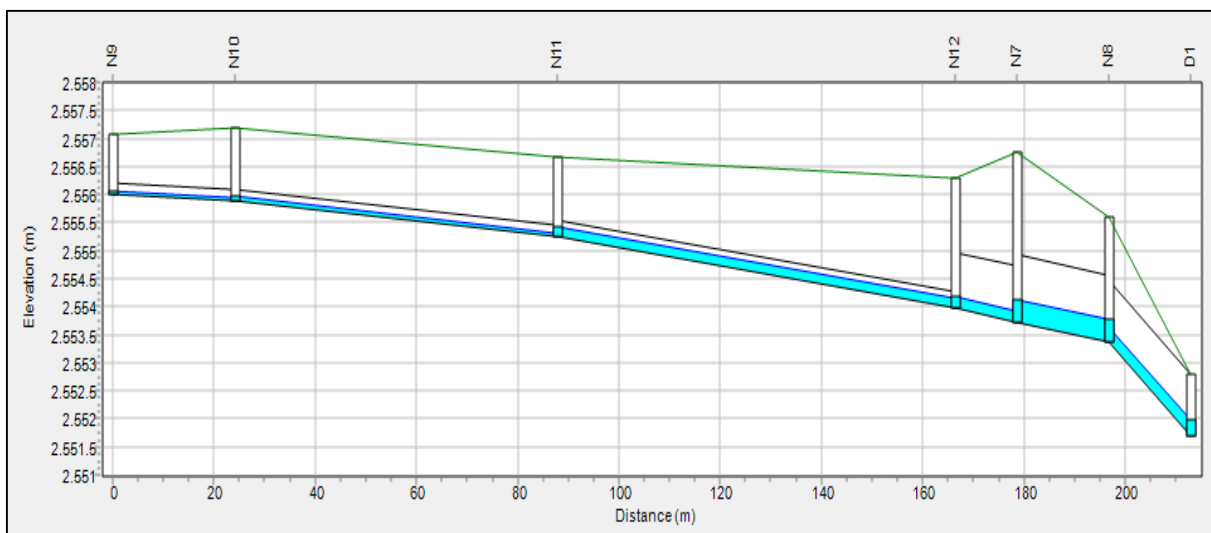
Perfil de alcantarillado pluvial que corresponde al tramo Carrera 9 entre Calles 108 - 110
